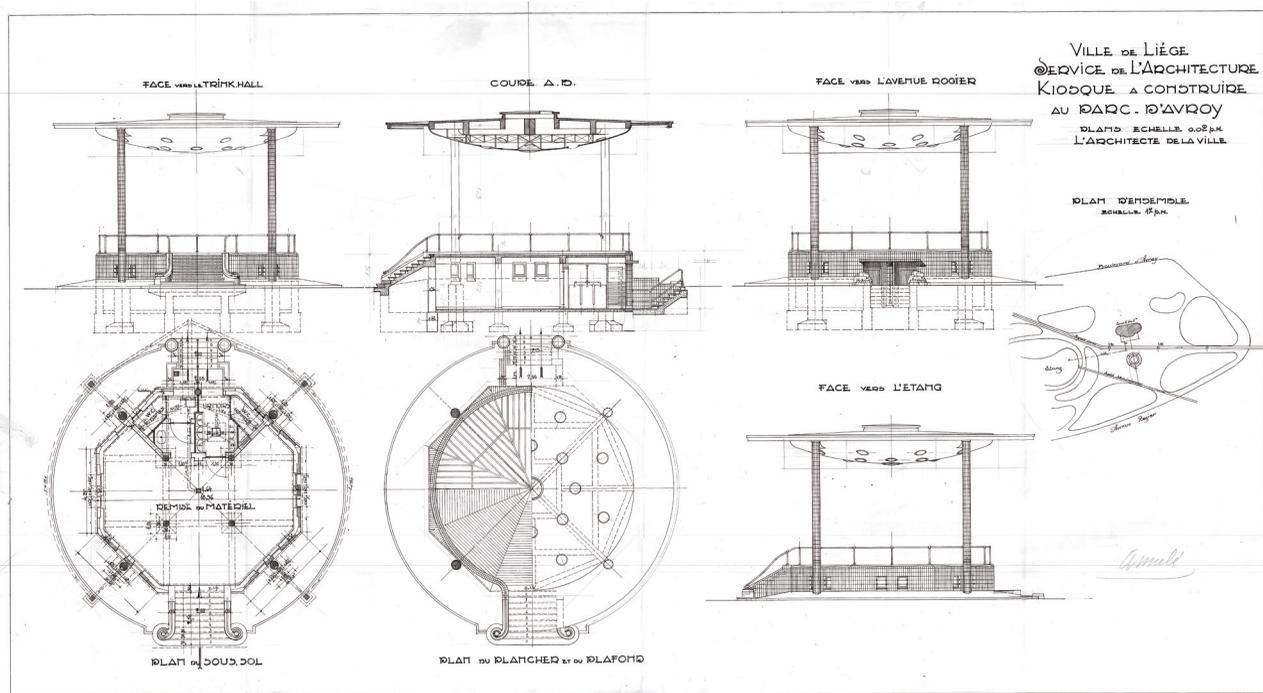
Jean Moutschen, plan du kiosque à installer au Parc d'Avroy.
